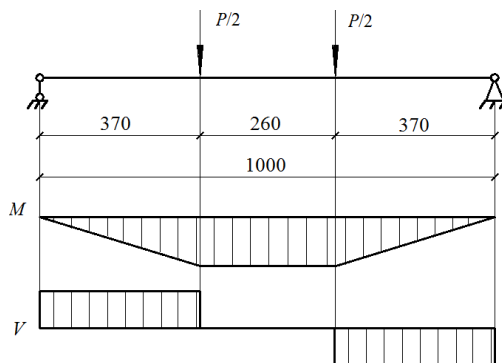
Расчетная схема балки и эпюры внутренних усилий
